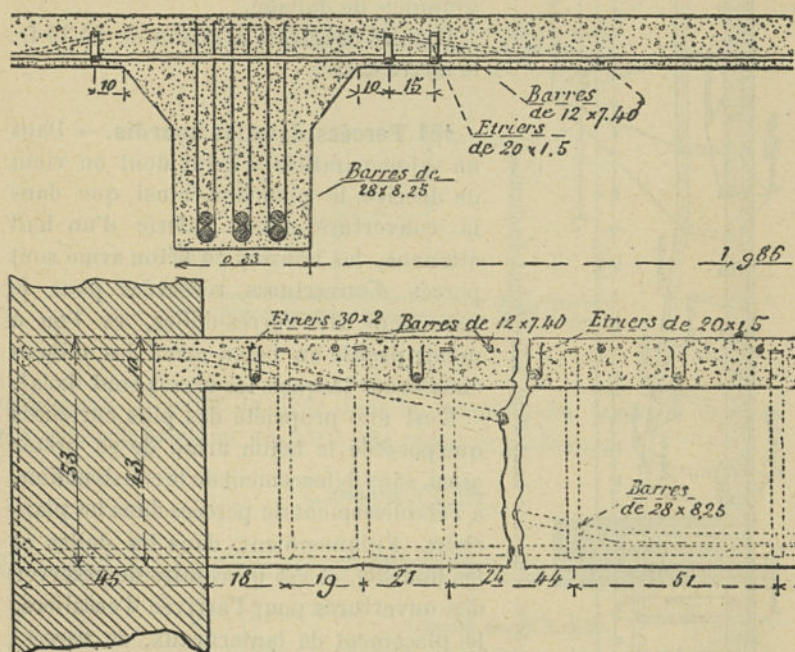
Petit Palais des Beaux-Arts. Plancher haut d'une galerie de l'étage de soubassement.
